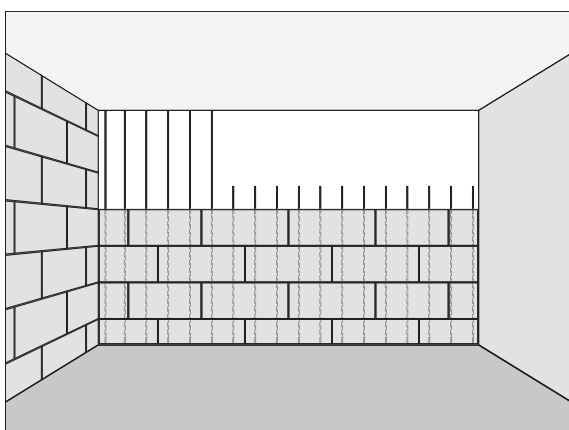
Montaż pierwszego elementu na listwach – montaż w pionie.
